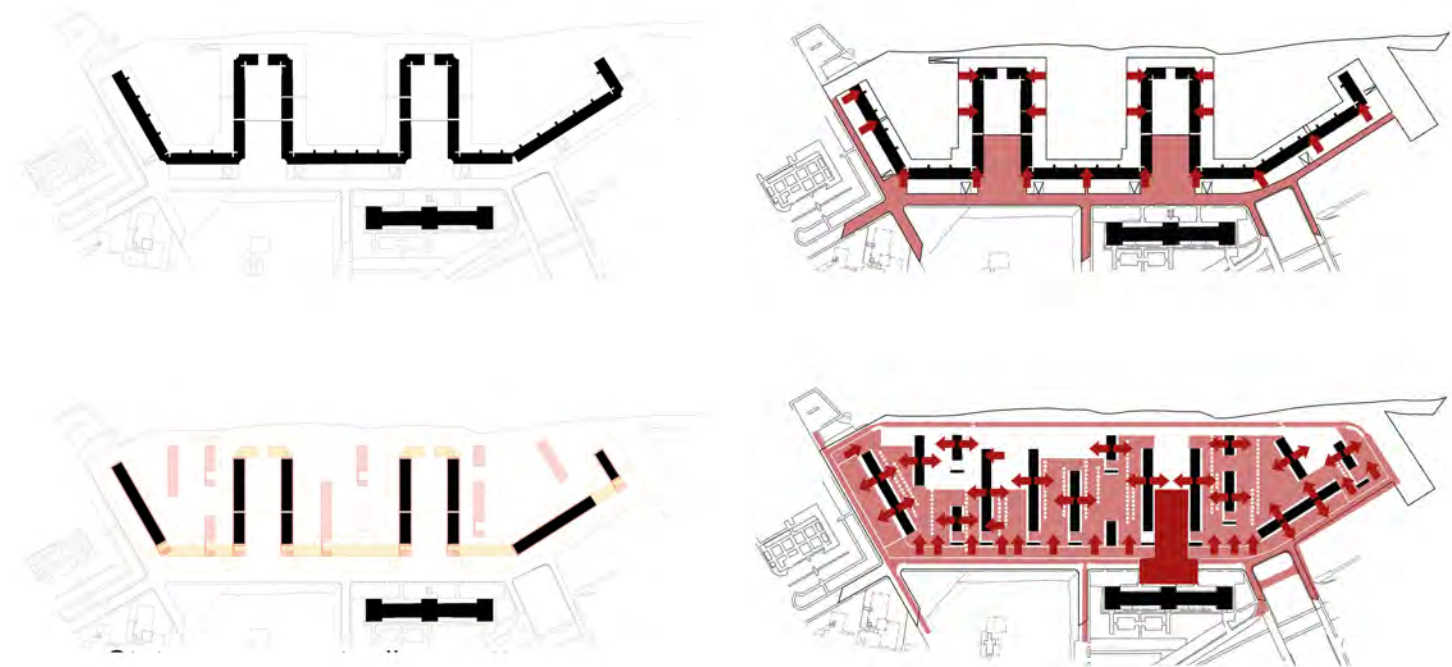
Planimetria dello stato di fatto e dello stato sovrapposto di progetto
